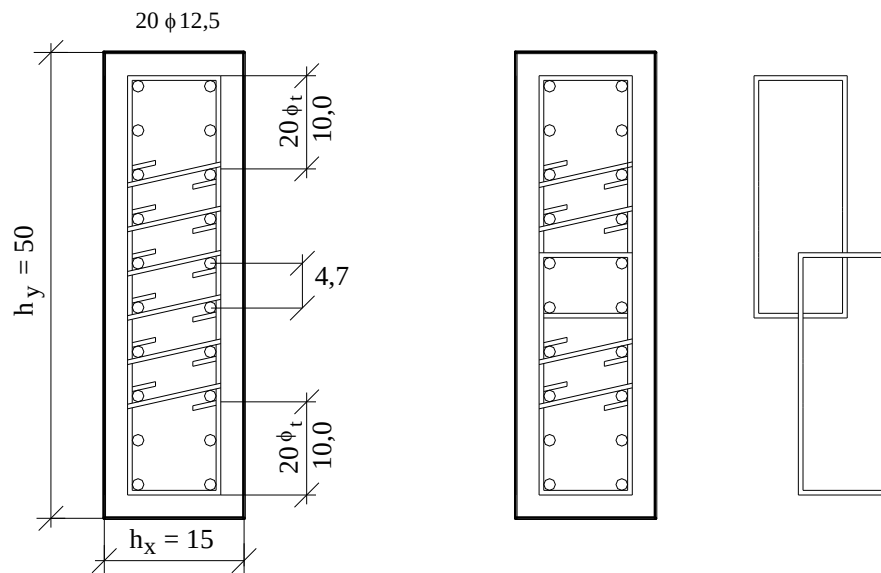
Detalhamento da armadura na seção transversal do pilar P8.
